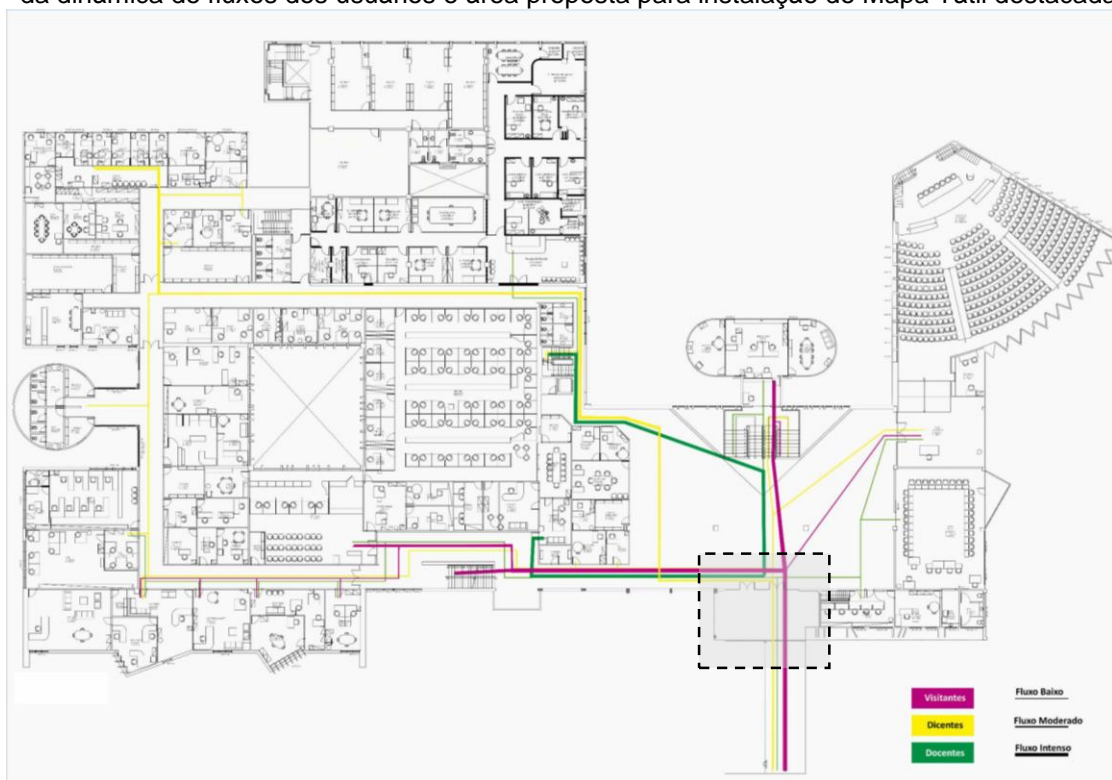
Planta baixa do primeiro pavimento do prédio da Reitoria da UFPB com os níveis de acesso demarcados e destacando a área proposta para instalação do Mapa Tátil
